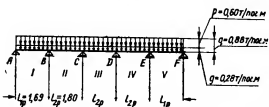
Расчетная схема плиты и расчетные нагрузки
